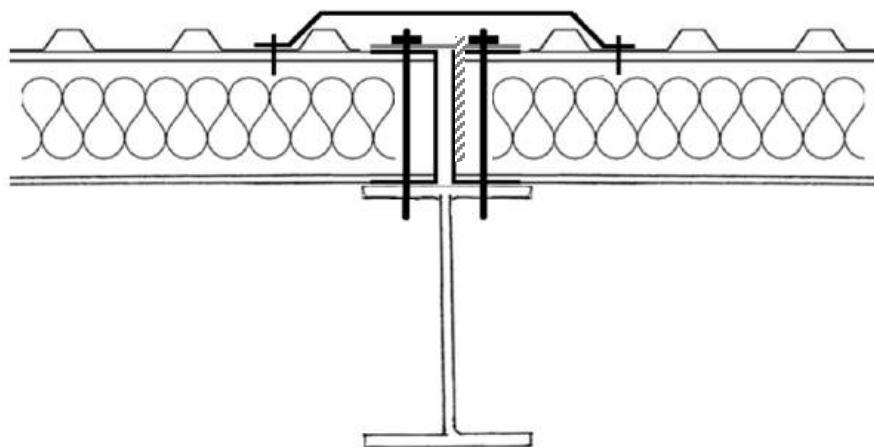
Utilisation d'une cassette isolée préfabriquée supportée par la semelle supérieure [5]
